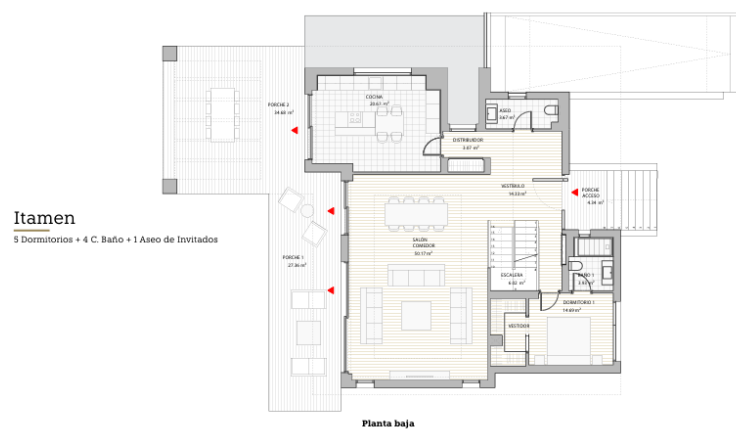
Plano de la planta baja de la vivienda (Fuente: Levitt - Constructora)
